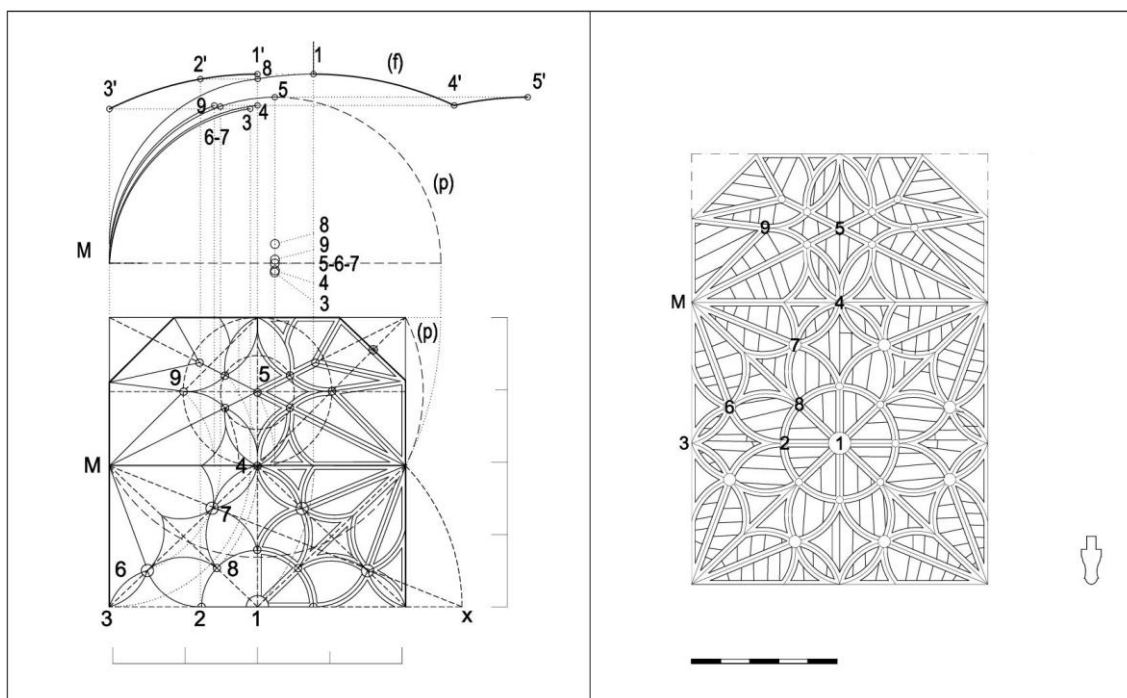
Abóbada da capela-mor da Sé de Braga. Figura esquerda: hipótese de traçado da planta e elevação. O arco principal (p) da diagonal é utilizado para a construção de todas as nervuras. O *rampante* (f) tem um raio equivalente ao dobro do raio de (p). O traçado das nervuras depende das cotas das chaves, determinada pelo *rampante* (f). Figura direita: planta com a disposição das aduelas da abóbada e o perfil das ogivas e *tiercerons*.
